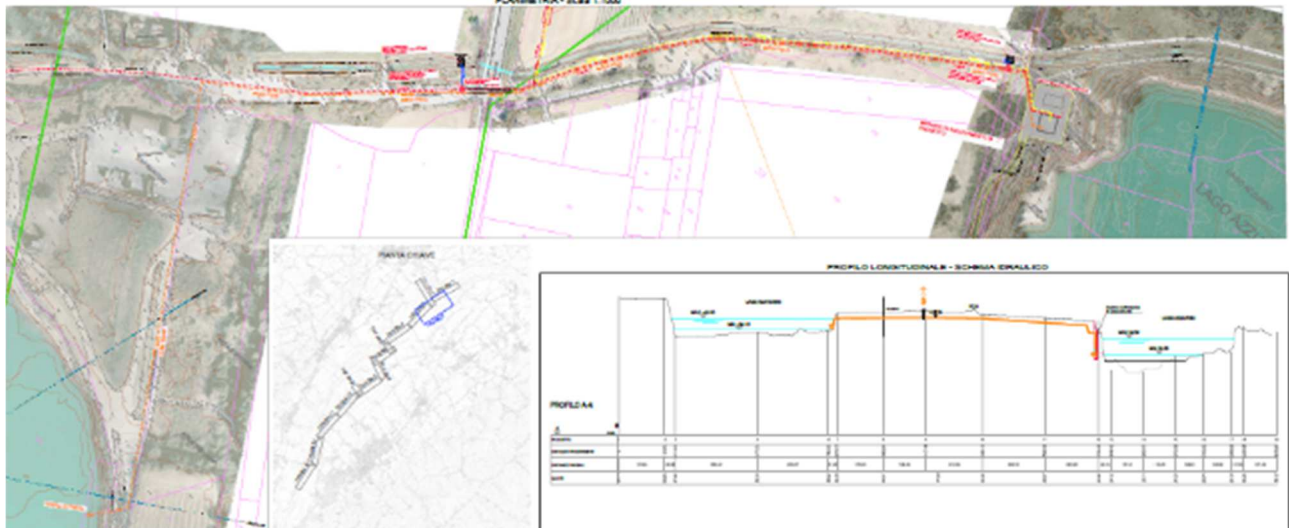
Planimetria e profilo della condotta di collegamento tra i laghi (tav. B.6.2)
